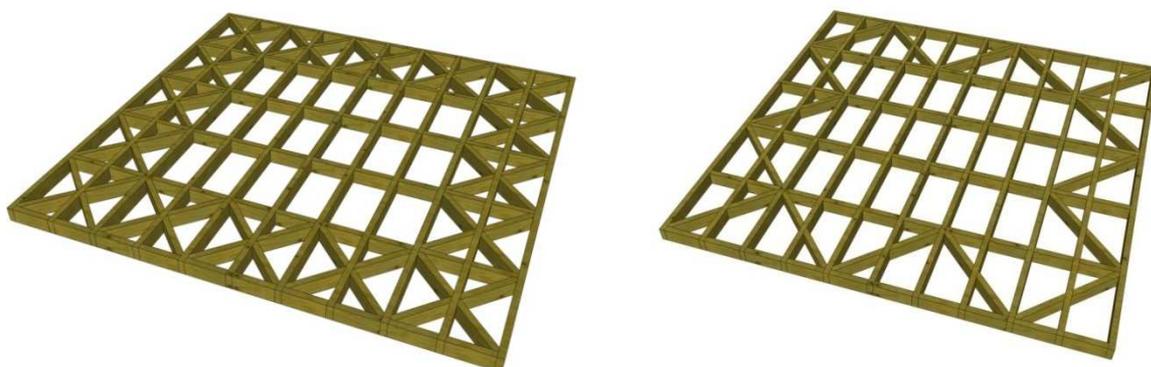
Exemples schématiques de diaphragmes de type poutre au vent sous plancher
